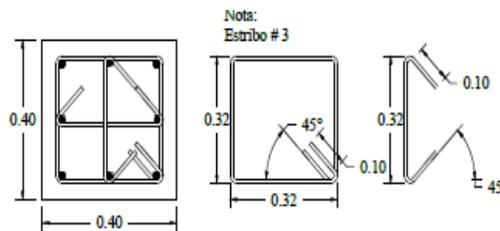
Despiece columnas eje 1 y eje 5 (Fuente: planos estructurales edificio calle 8N#11-36)
